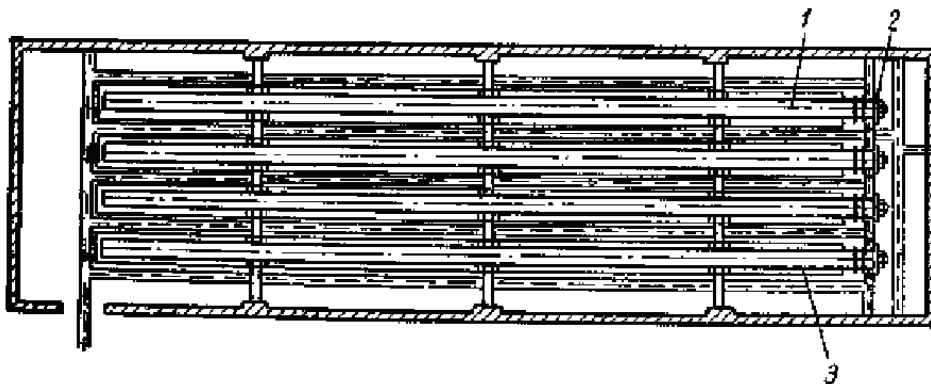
Камера охолодження м'яса з міжшляховими повітроохолоджувачами з гладких труб: 1 – повітроводи з соплами; 2 – вентилятори з електродвигунами; 3 – батареї
